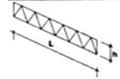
Detalle en vista de la aplicación de las vigas Joist
